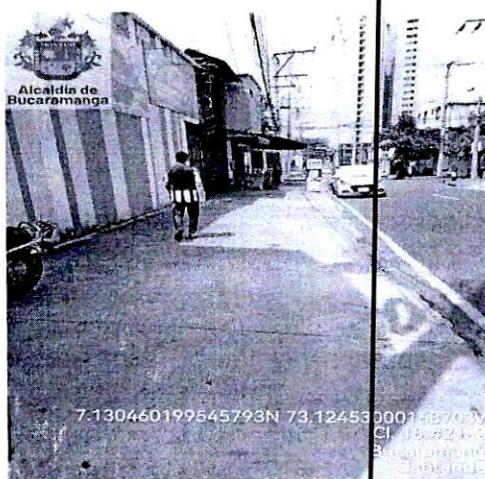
Perfil del costado Sur en la calle 18 con carrera 21.
